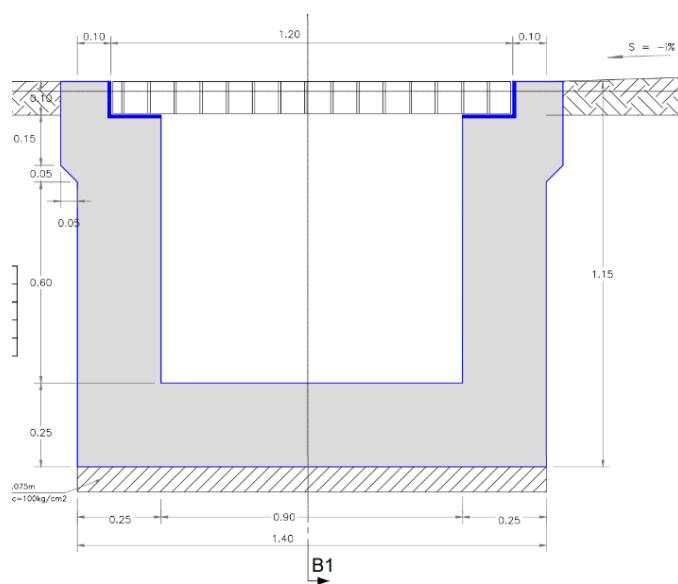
Detalle de canal rectangular TIPO I con Rejilla
